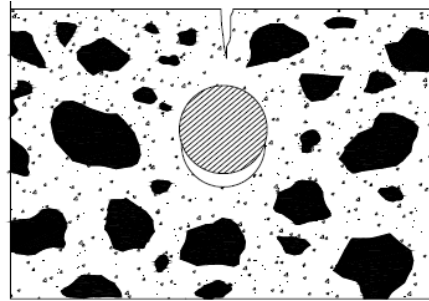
Fisura formada debido a una precipitación obstruida.
